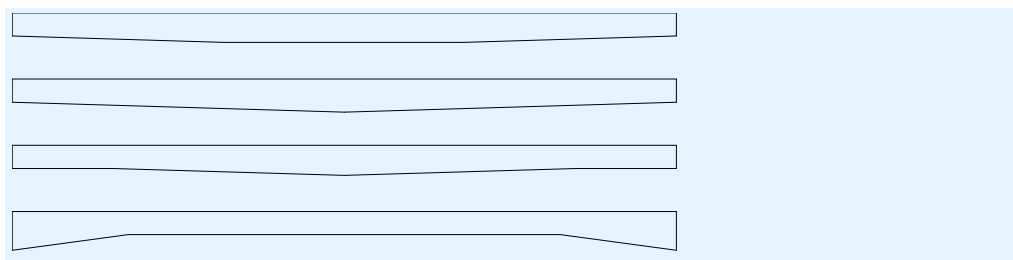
Konstrukcje typu belka-słup z ramą przegubową
